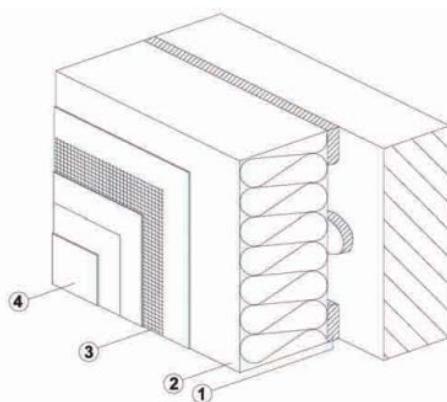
Modelizado en BIM (Revit) de fachada FFL-6 tipo 1. Fuente: propia.
